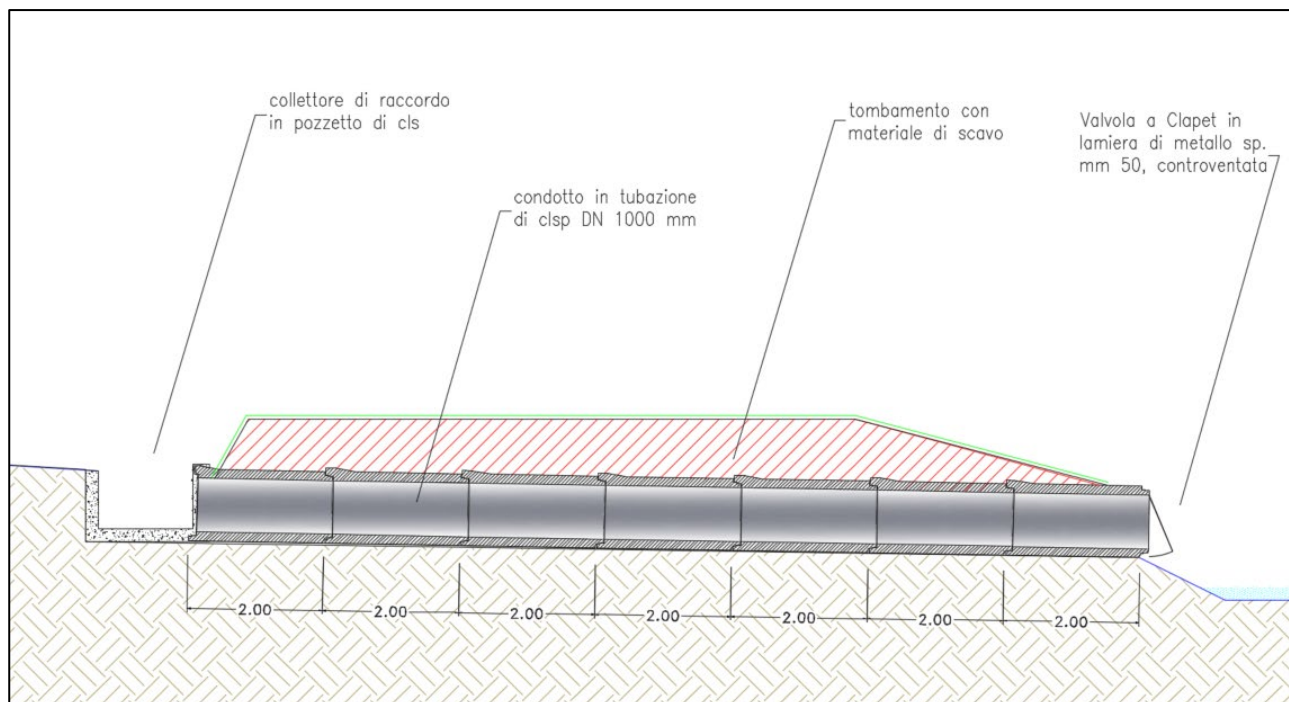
Canale Scovalasino – Particolare della costruzione della ventola in sx idraulica a monte dell'attraversamento dell'Autostrada A21.
